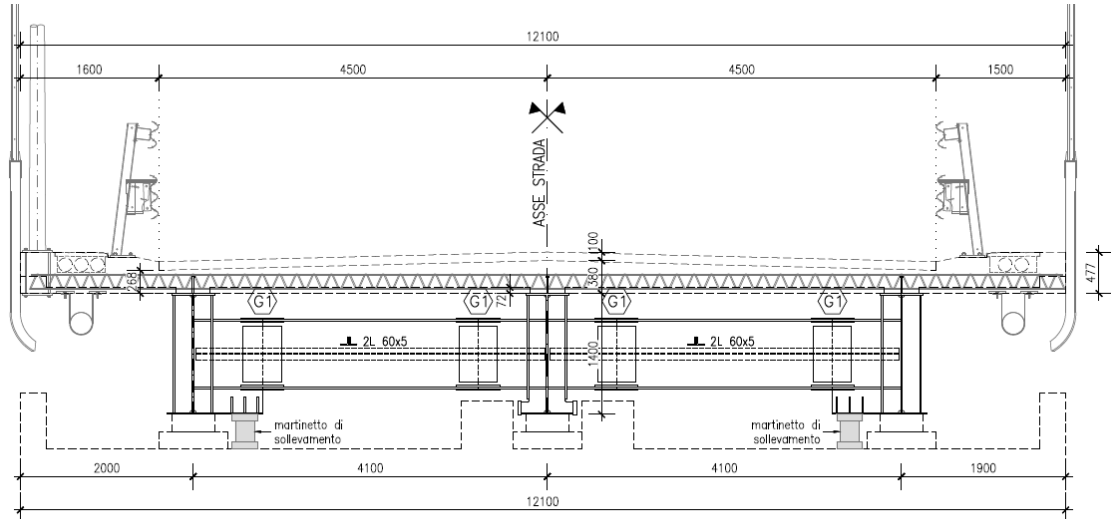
Sezione trasversale dell'impalcato in corrispondenza della spalla
